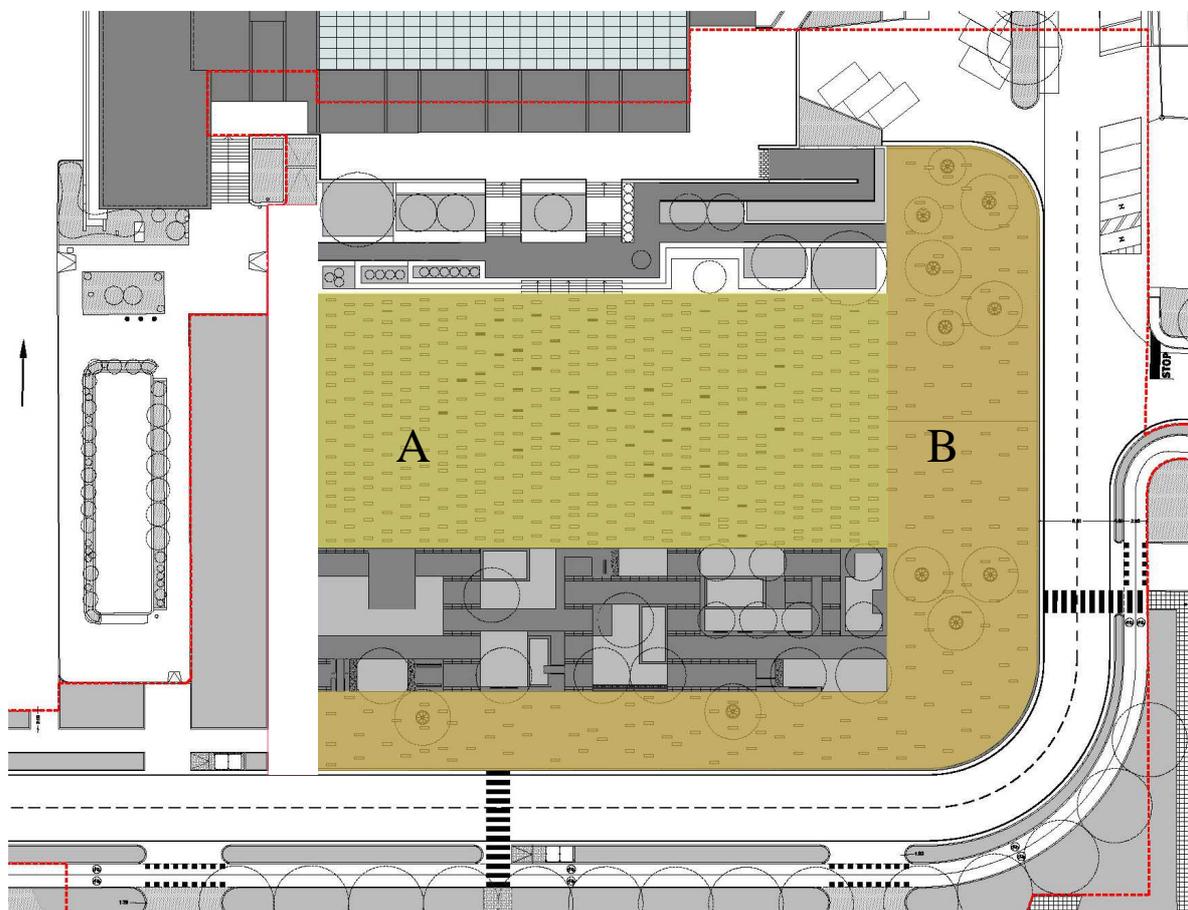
Planimetria delle principali aree di differenziazione della pavimentazione.
